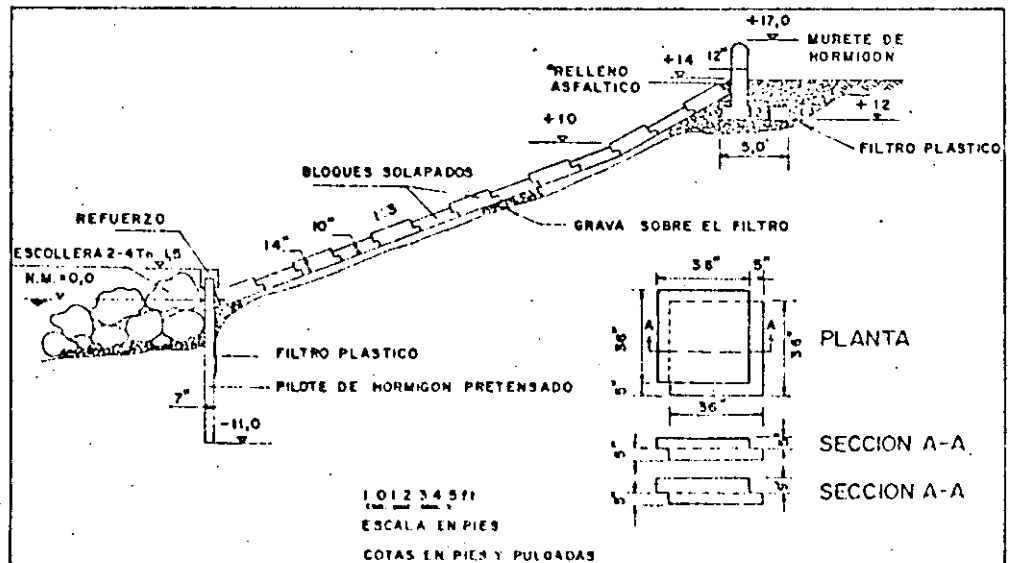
Revestimiento de las losas de hormigón solapadas
